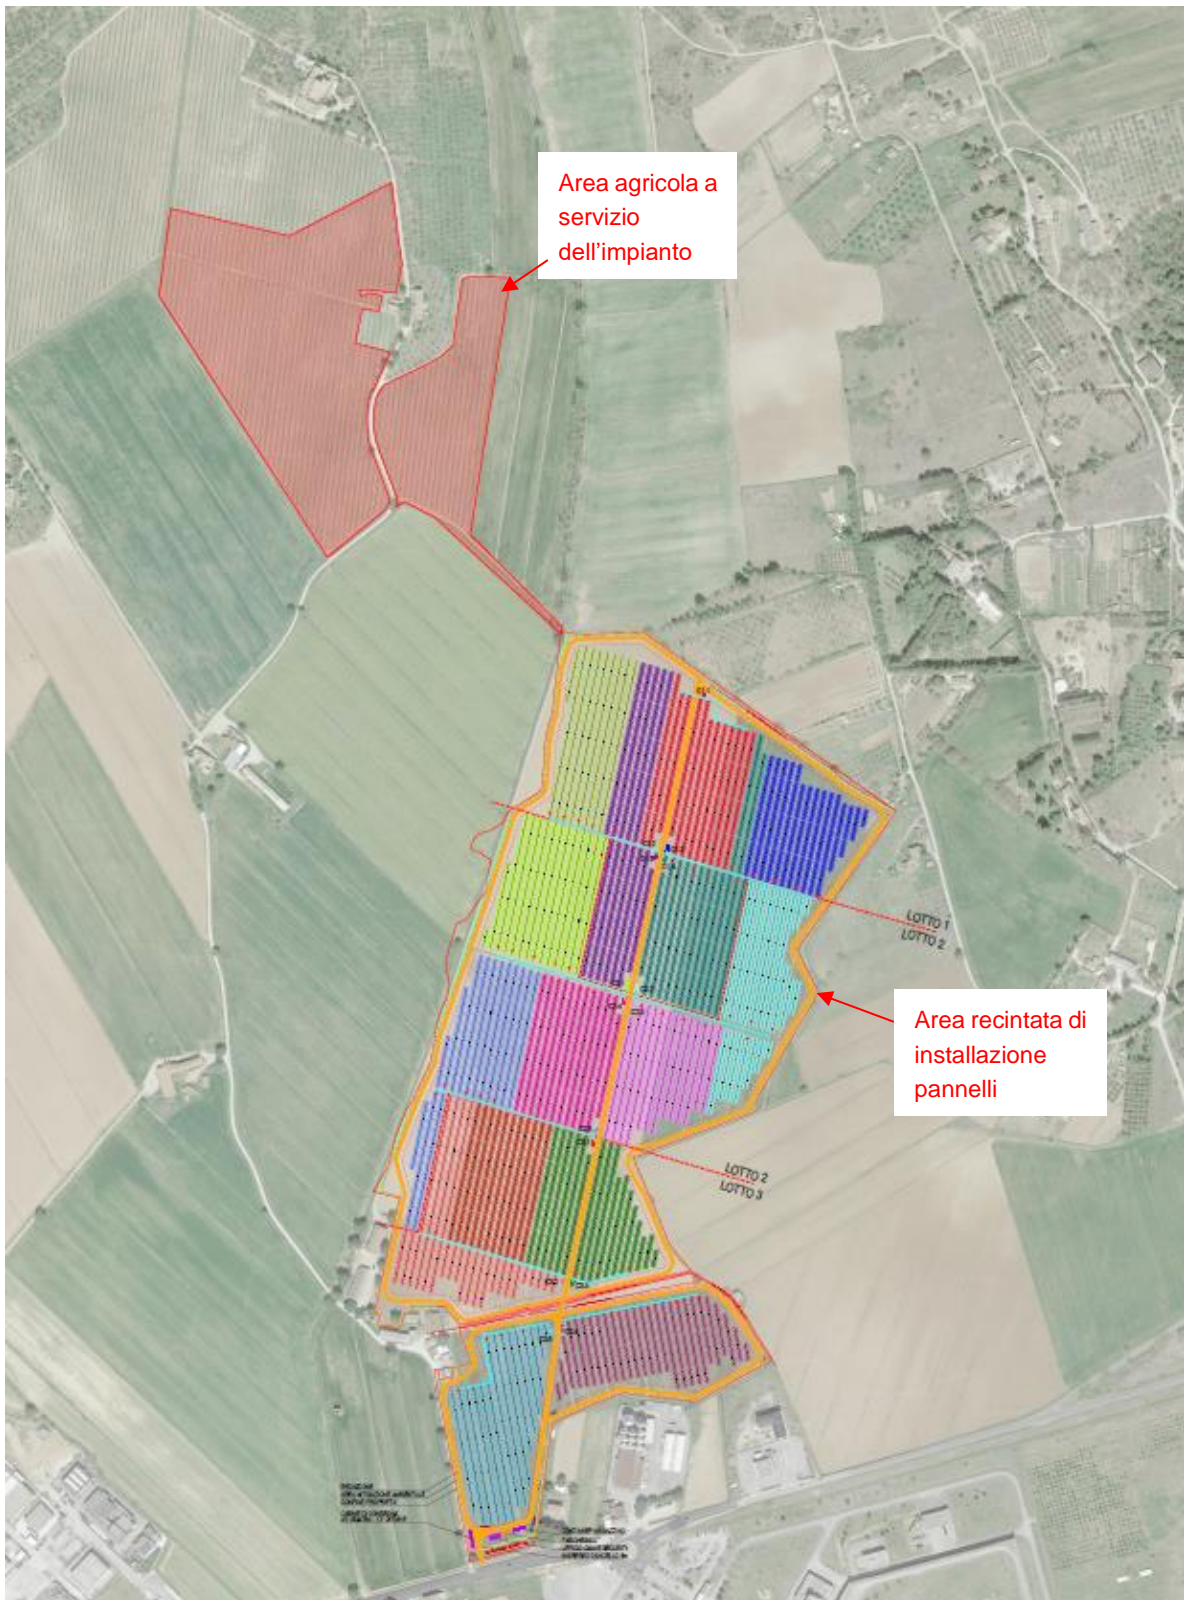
Layout impianto (Relazione descrittiva generale)
